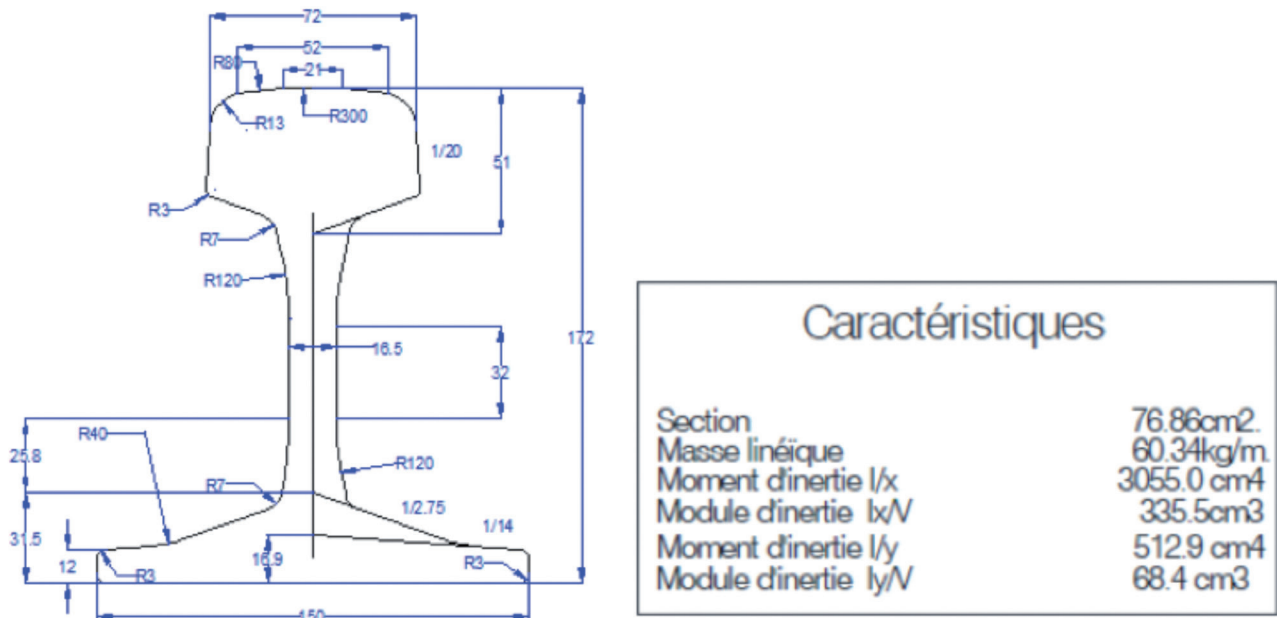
Rail 60E1 – Norme NF EN 13674-1
